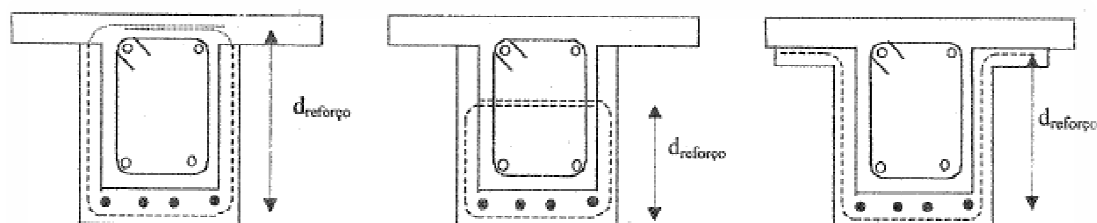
Disposições de armaduras mais utilizadas no reforço ao esforço transversal utilizando a técnica de encamisamento (Carreira, 2000).
